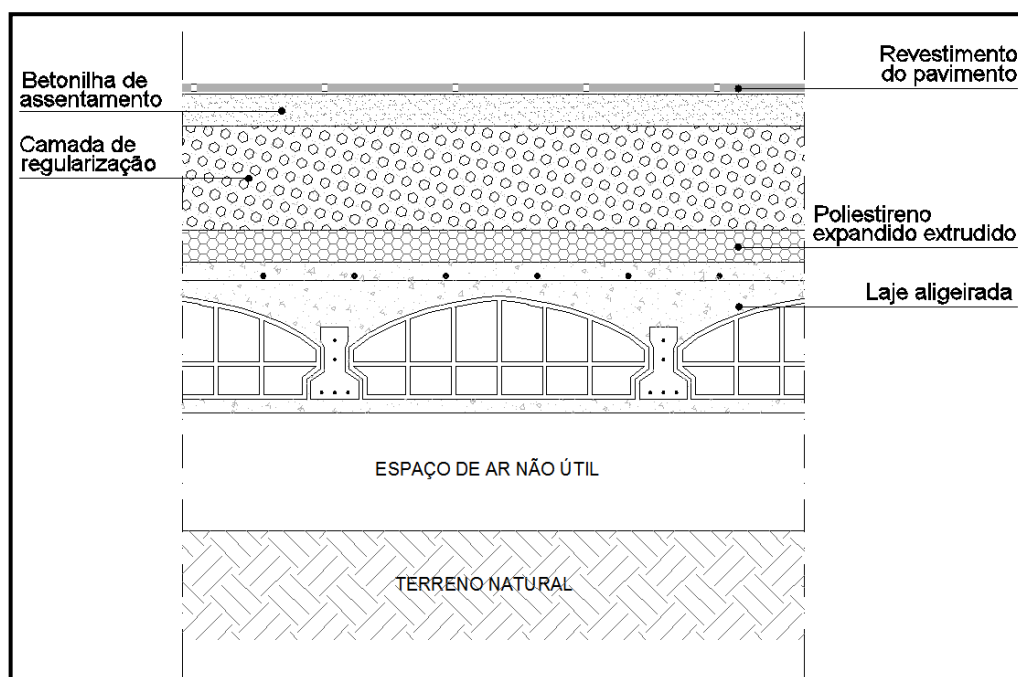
Pormenor do pavimento do piso térreo, no rés do chão, em corte (PAV02)
